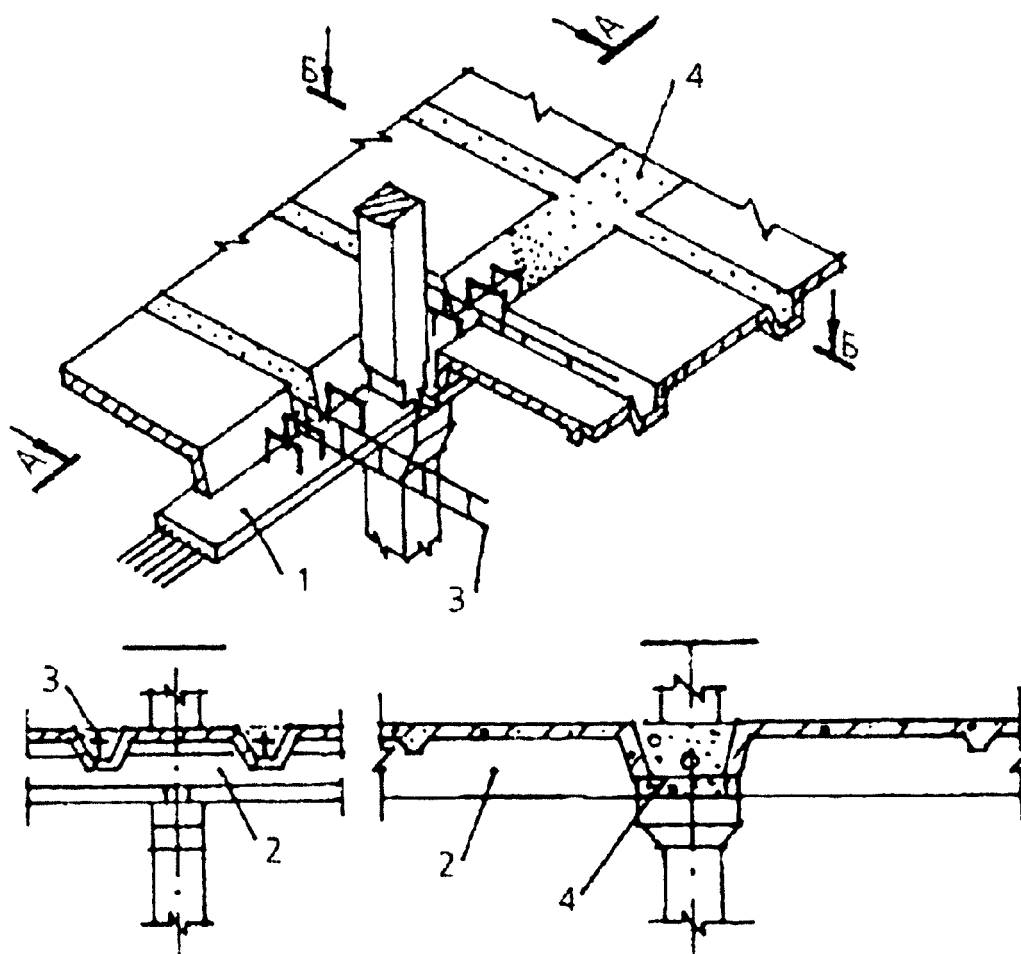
Сборно-монолитные перекрытия: 1 - днище главной балки; 2 - предварительно напряженная панель; 3 - опорный стыковой каркас; 4 - бетон замоноличивания
